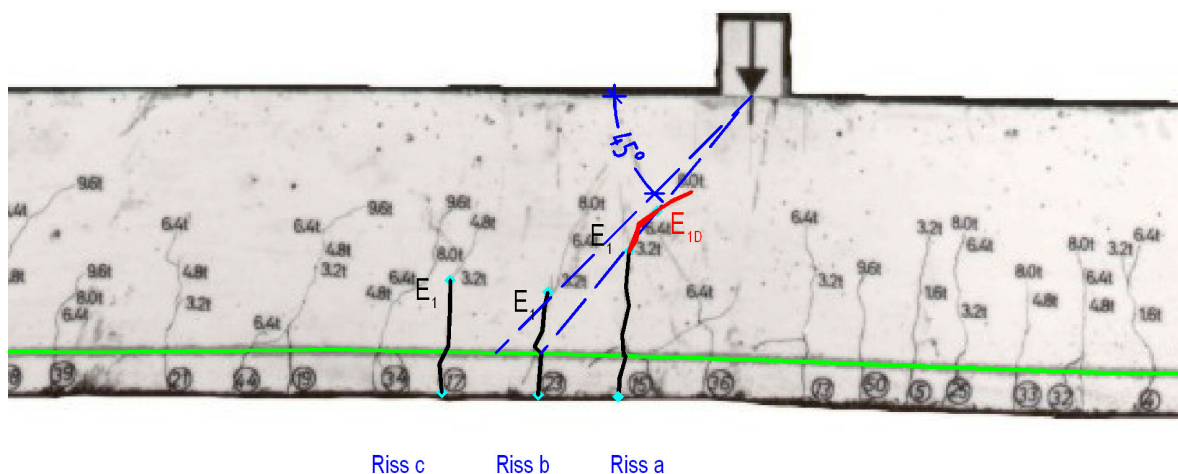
Rissbild im Kraffteinleitungsbereich (linker Teil) des Balkens 9/1 aus [2.4]
